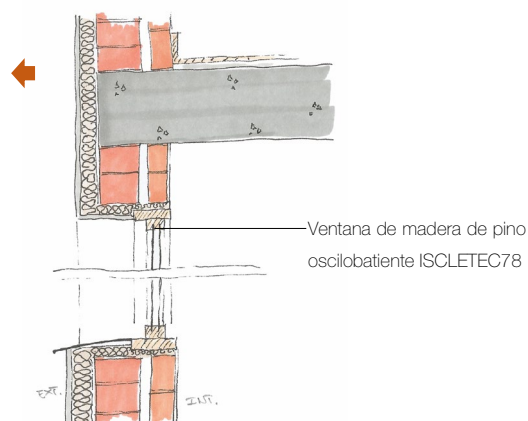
Detalle constructivo del hueco de ventana con el sistema SATE aplicado en la envolvente vertical (autoría propia).
